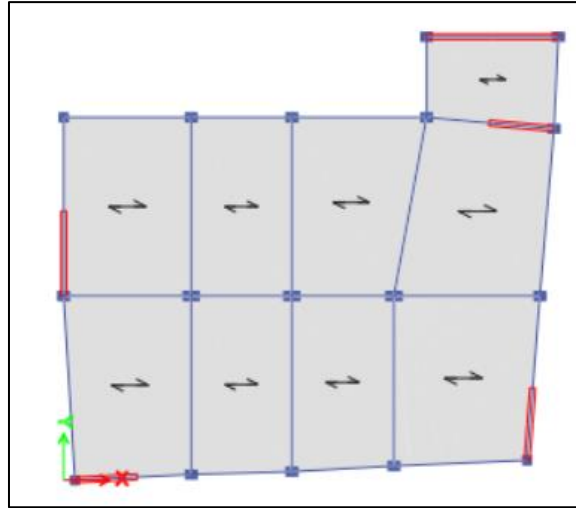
vue en plan du plancher terrasse (élévation R+12).
